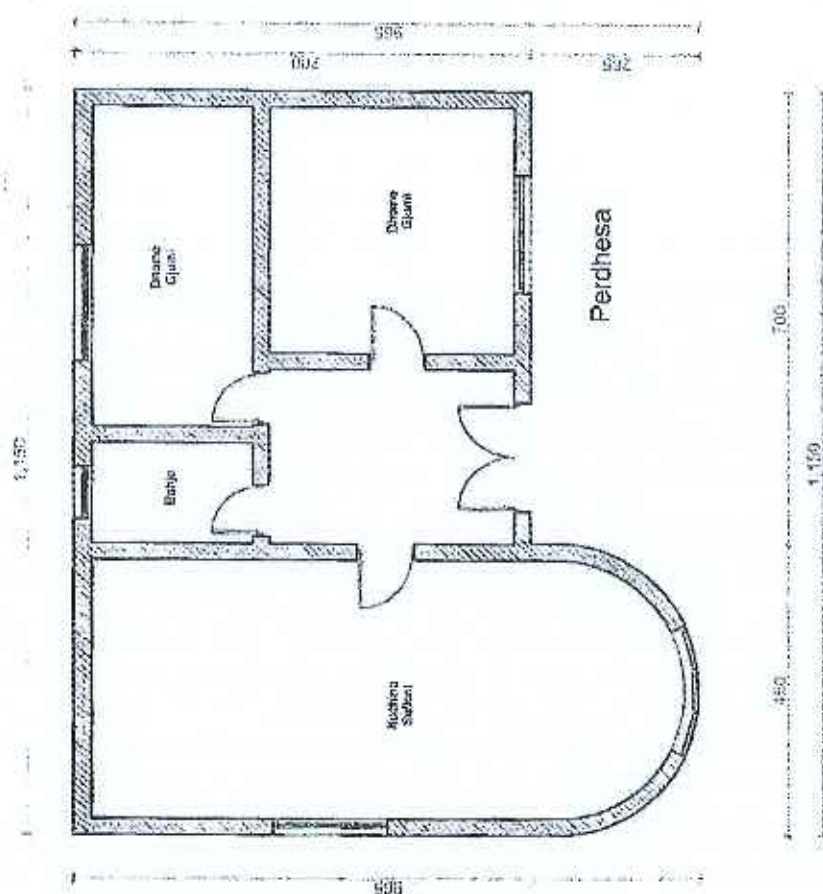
Planimetria e përdhësës së objektit me etazhitet B+P–bashkangjitur në Formularin e Inqizimit të Strukturës
